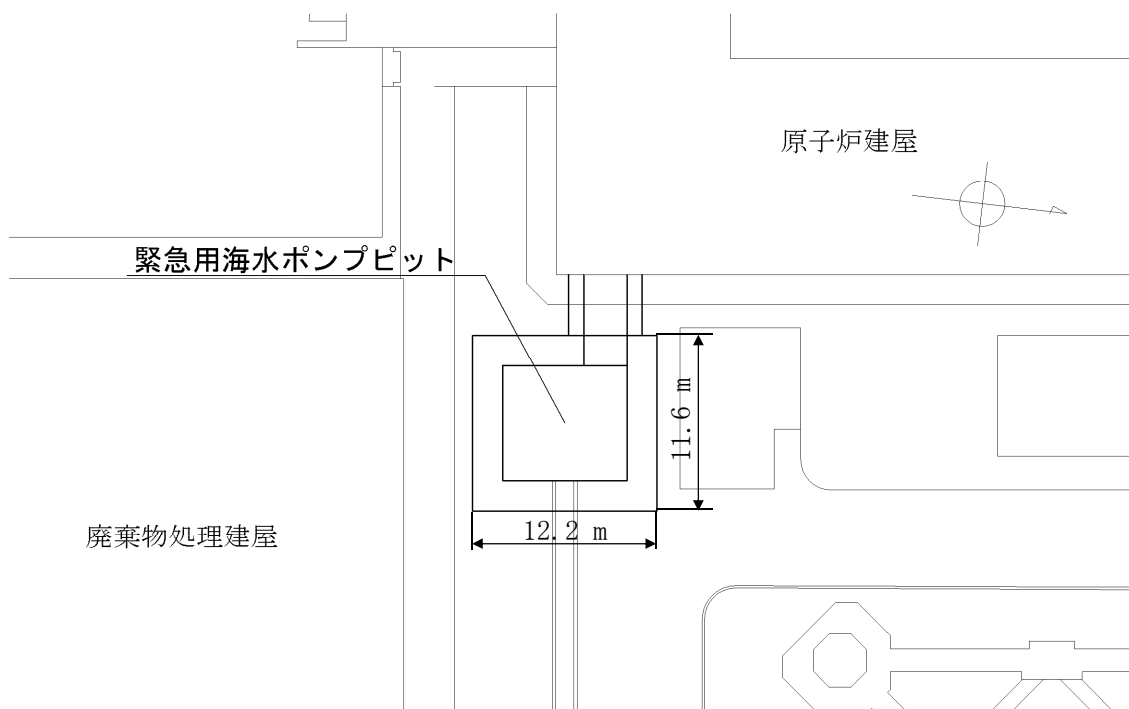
(2) 緊急用海水ポンプピット位置図
